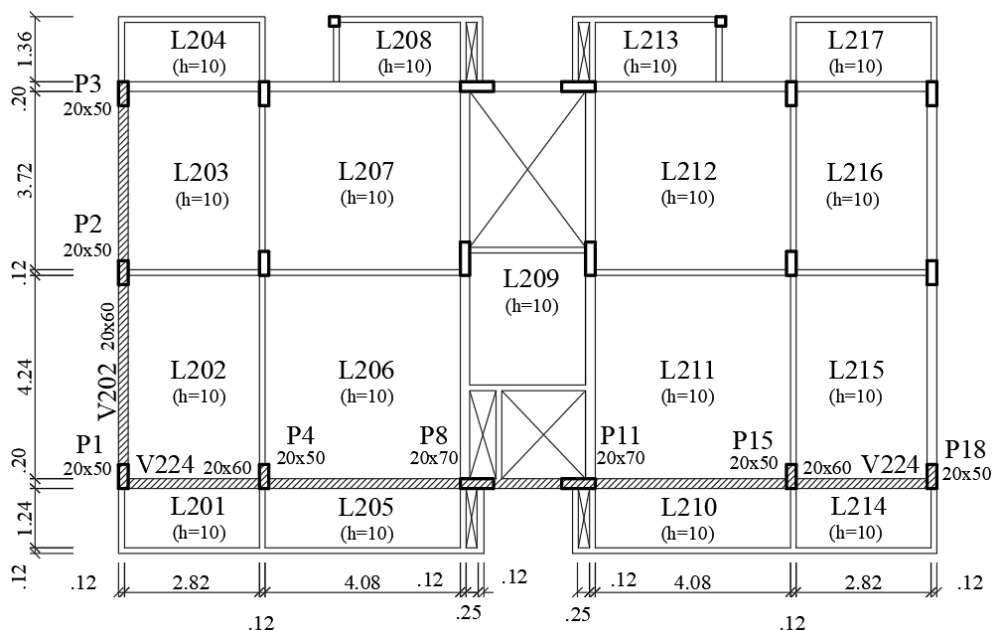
Planta de formas do pavimento tipo do edifício modelo.
